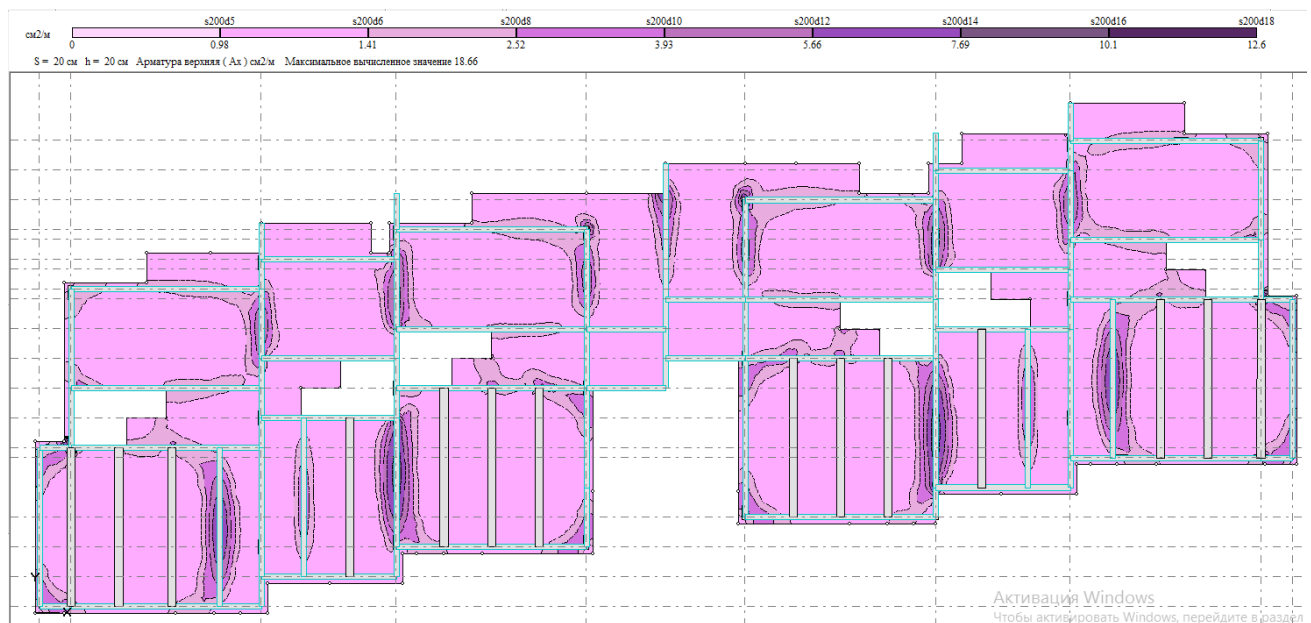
Верхня арматура плити перекриття на відм. 0.000 у напрямку осі X (A_x)
